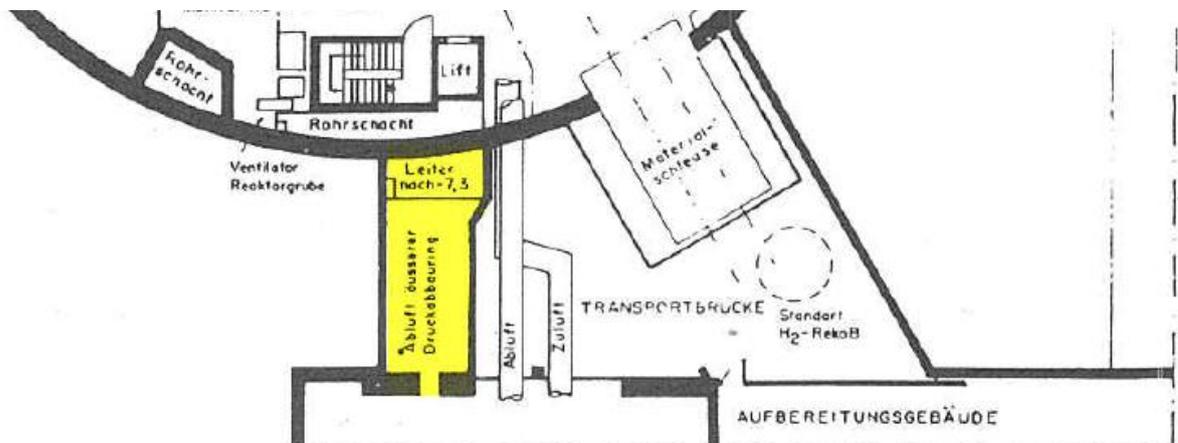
KKM Sicherheitsbericht 1989, Figur 12.1.3.b, Reaktorgebäude Grundrisse + 8 m [...] (Ausschnitt), 30.11.1989
